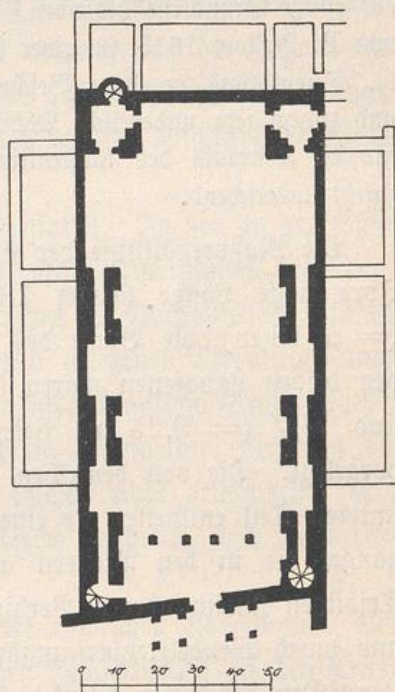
Douai. Jesuitenkirche. Grundriß und Erweiterungsplan.
